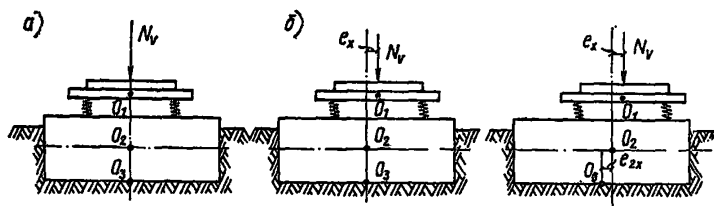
Схемы установки на фундамент виброплощадок с вертикально направленной возмущающей силой
